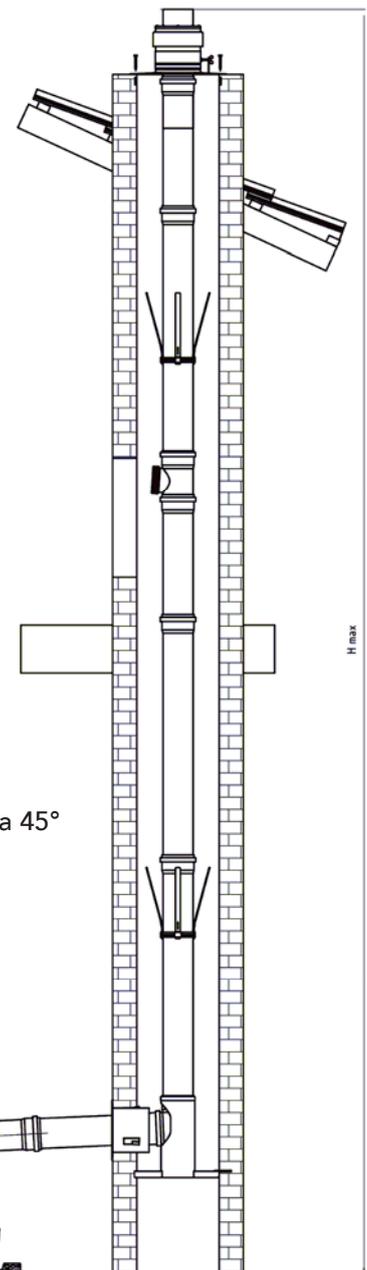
LAS 80/125 Außenwand mit Dachdurchführung
